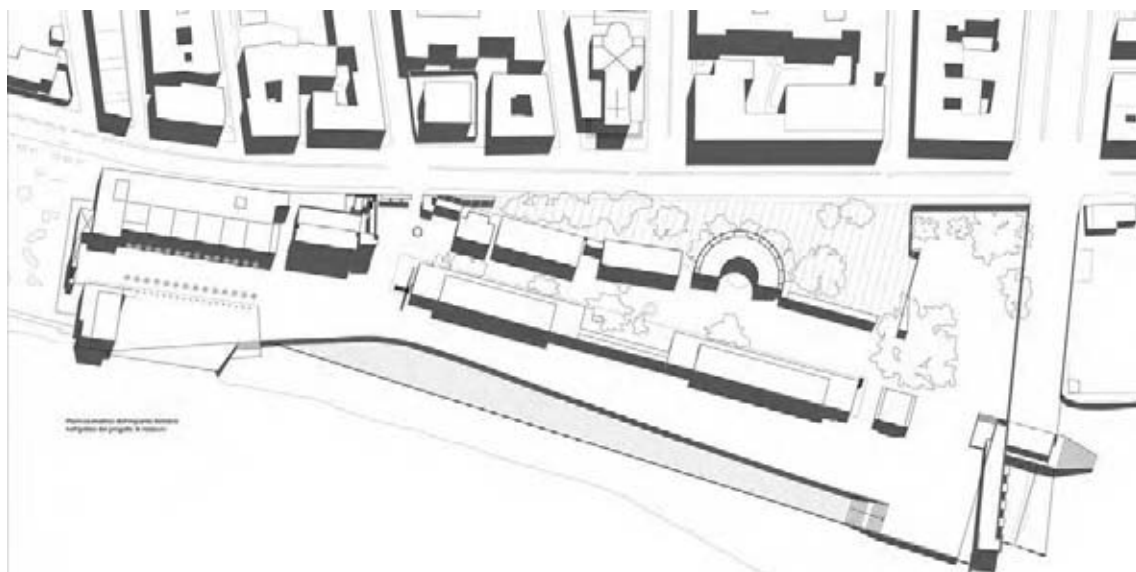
Planimetria dell'impianto fieristico, marzo 2007
